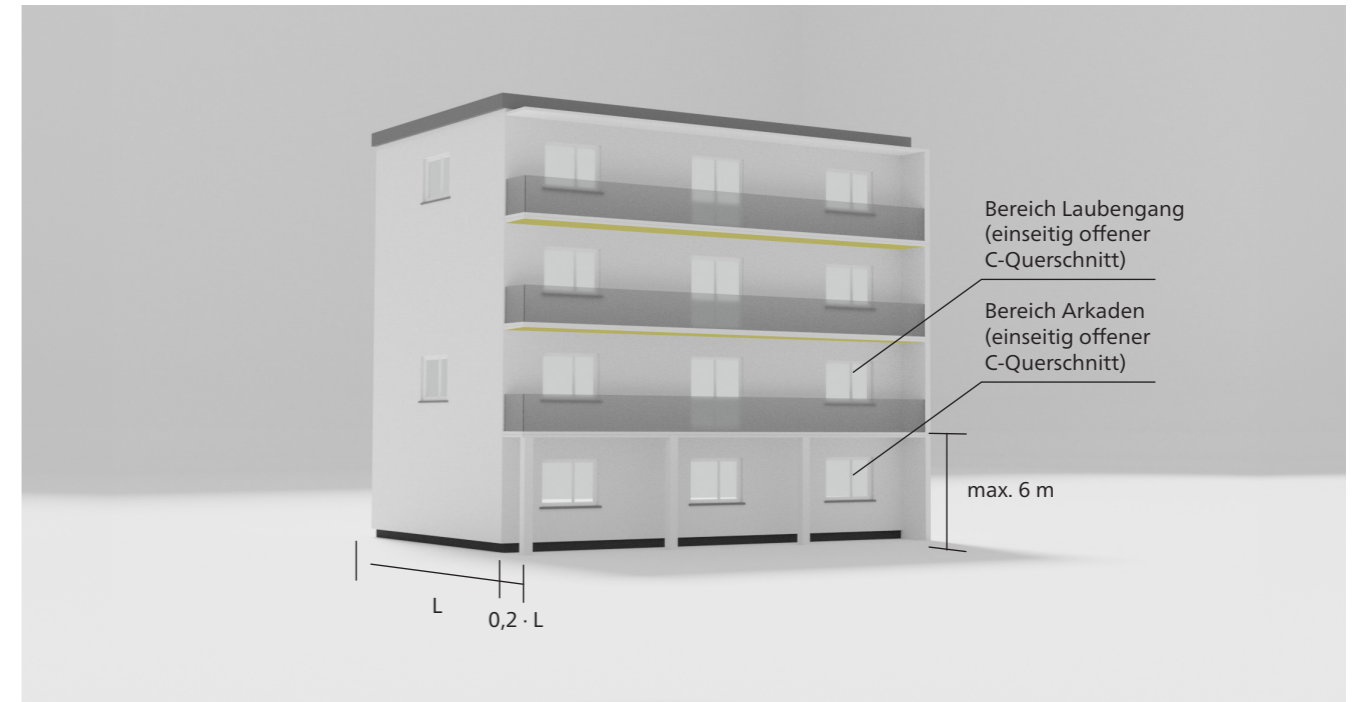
Schematische Darstellung von Laubengängen und Arkaden mit nach außen offenem C-förmigem Querschnitt
